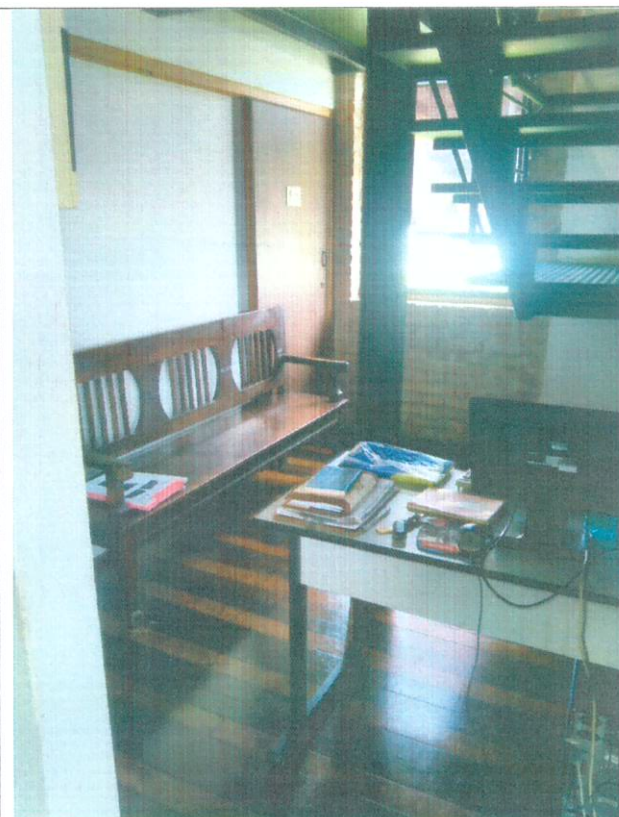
acesso ao sanitário acessível bloqueado por elemento estrutural - pilar e banco
